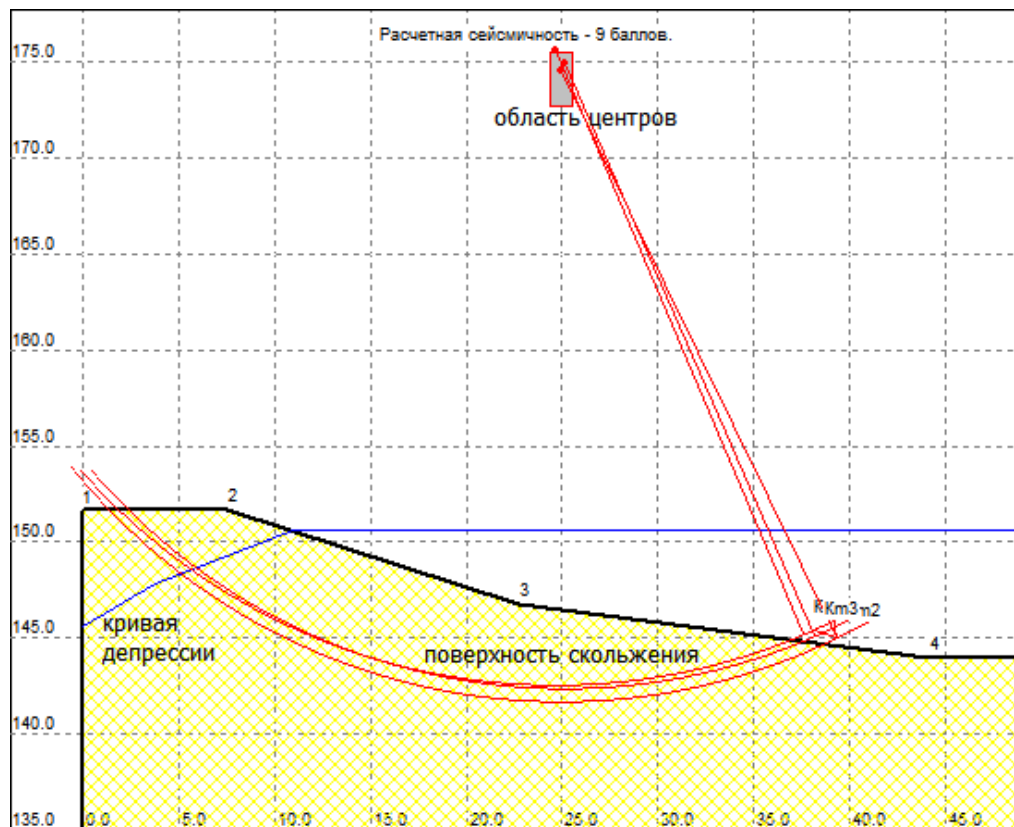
Расчетная схема к определению коэффициента запаса устойчивости верхового откоса дамбы Бахчисарайского водохранилища для основного случая нагрузок
